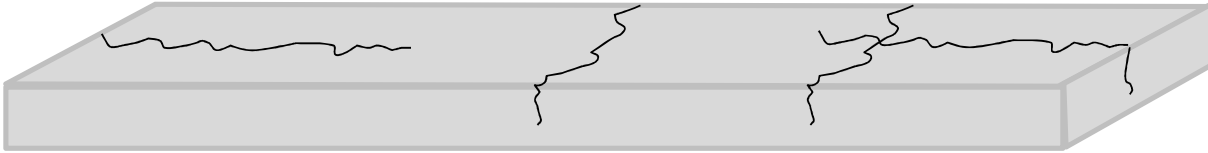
Fisuración en una losa sin juntas. (1) Transversal. (2) Longitudinal
